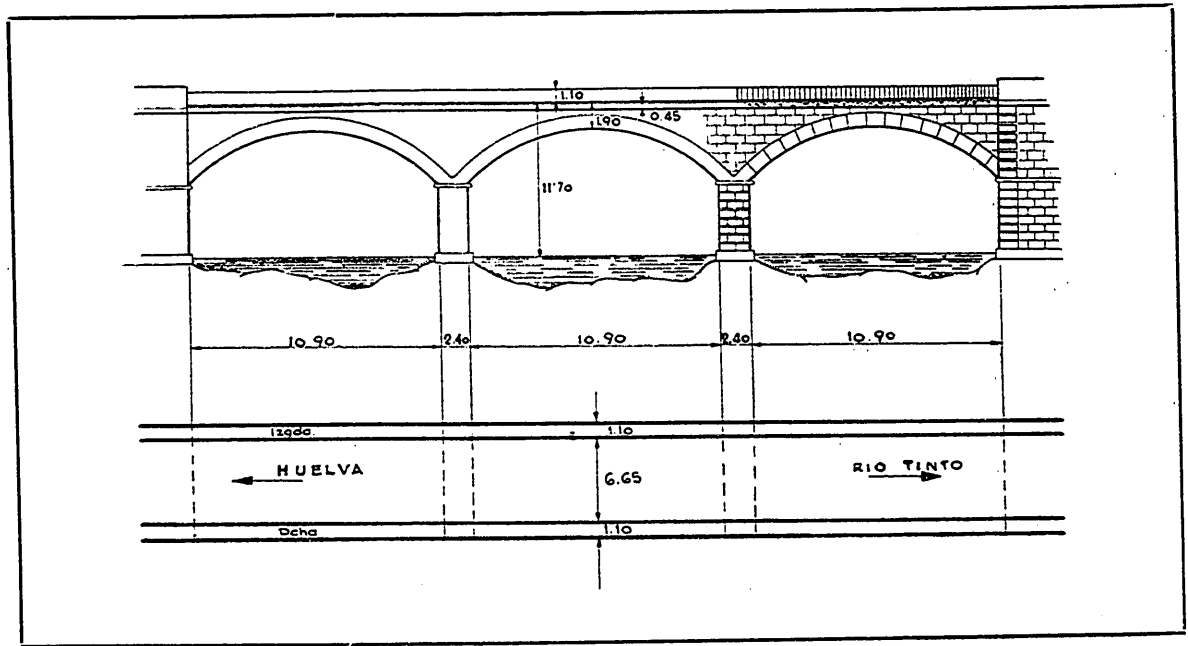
ª — Hoja de estructuras (reverso con croquis acotado).
